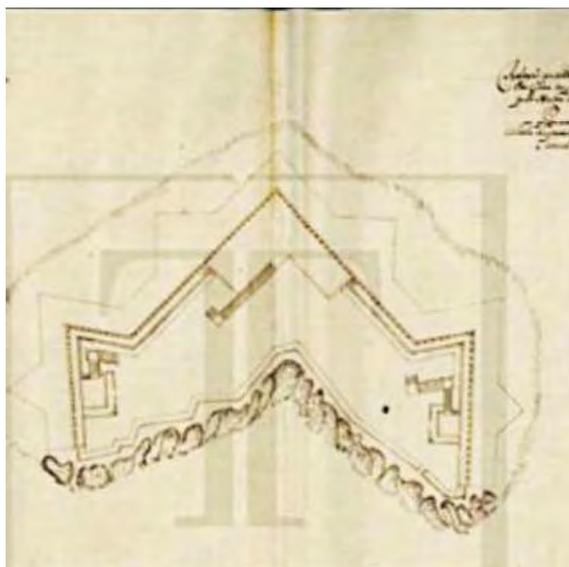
Planta do Forte (Arquivo da Torre do Tombo).
